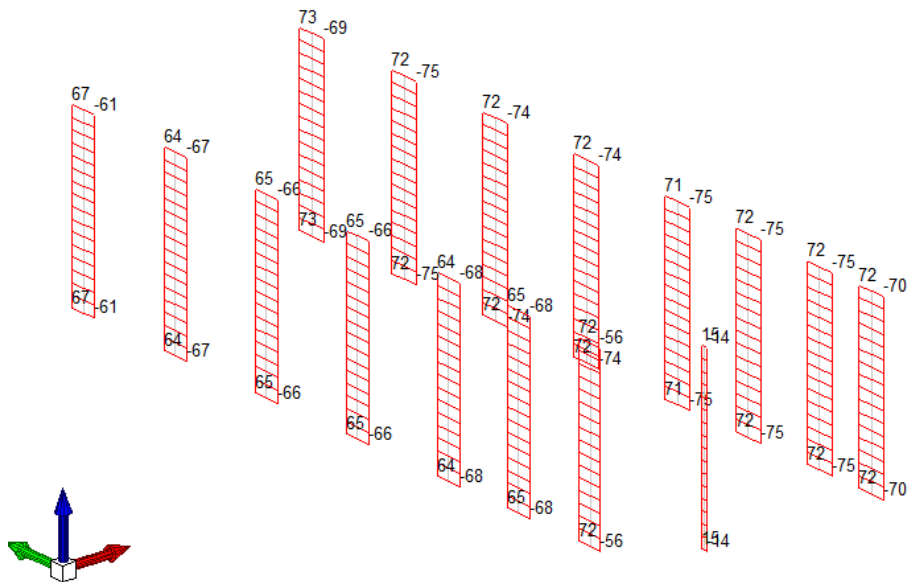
2 – Pilastri: inviluppo Taglio T 2-2 [kN]
